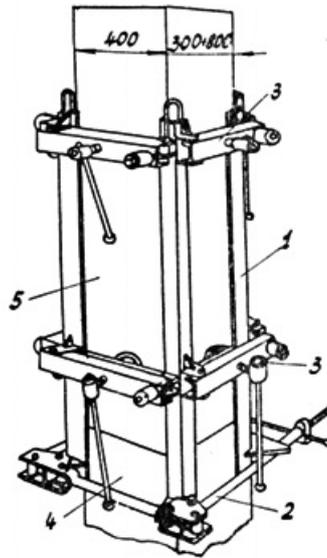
Одиночный разъемный кондуктор со стяжными винтами
